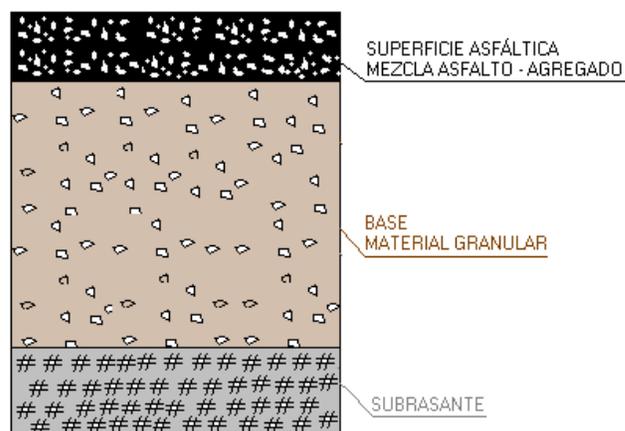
ESQUEMA PAVIMENTO ASFÁLTICO
